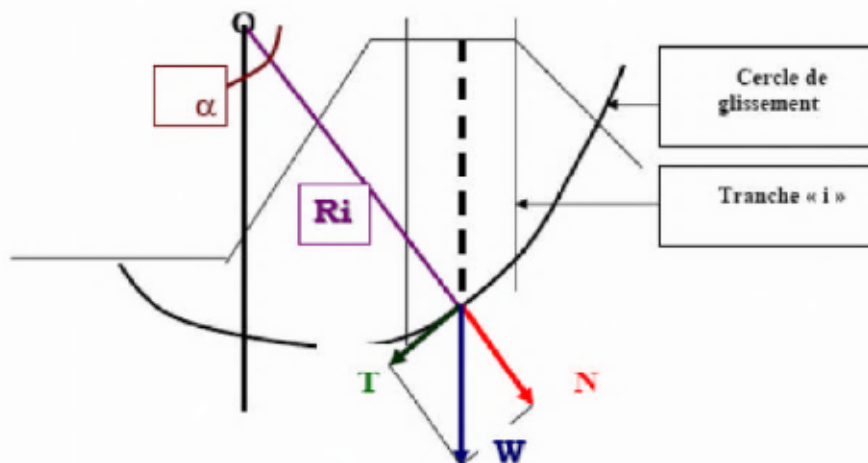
forces exercées par une tranche de sol instable sur le cercle de glissement (O, Ri)
